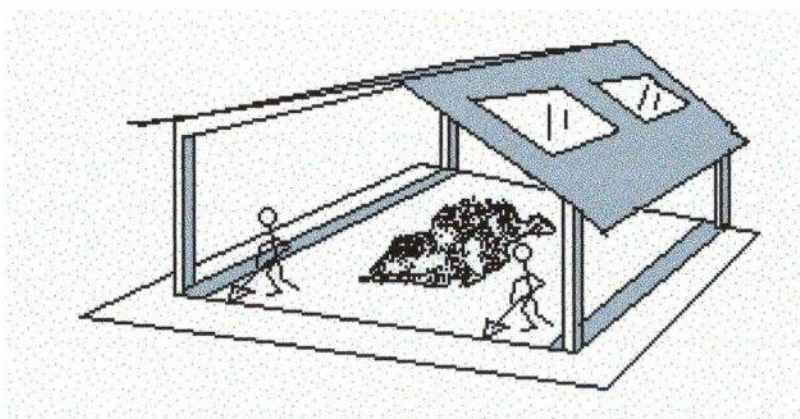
Primeira concepção construtiva do módulo RECEPÇÃO – CROQUI.
